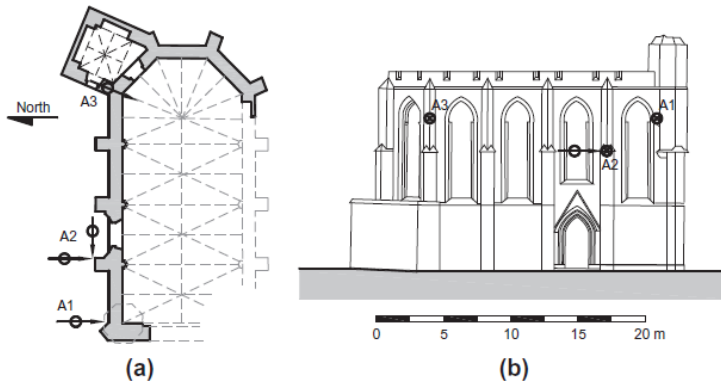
Pianta delle posizioni degli accelerometri nella Chiesa di St. George dei Latini: pianta a sinistra e prospetto Nord a destra
